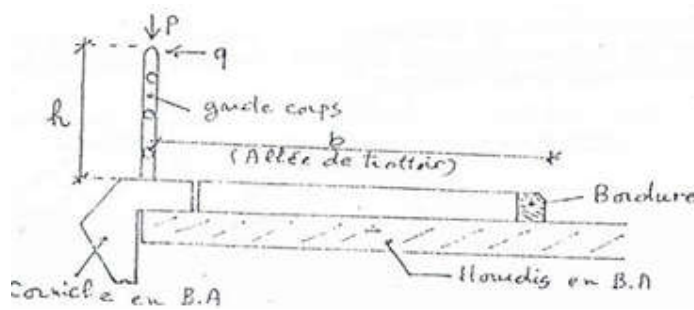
coupe transversale sur le trottoir et le garde-corps
